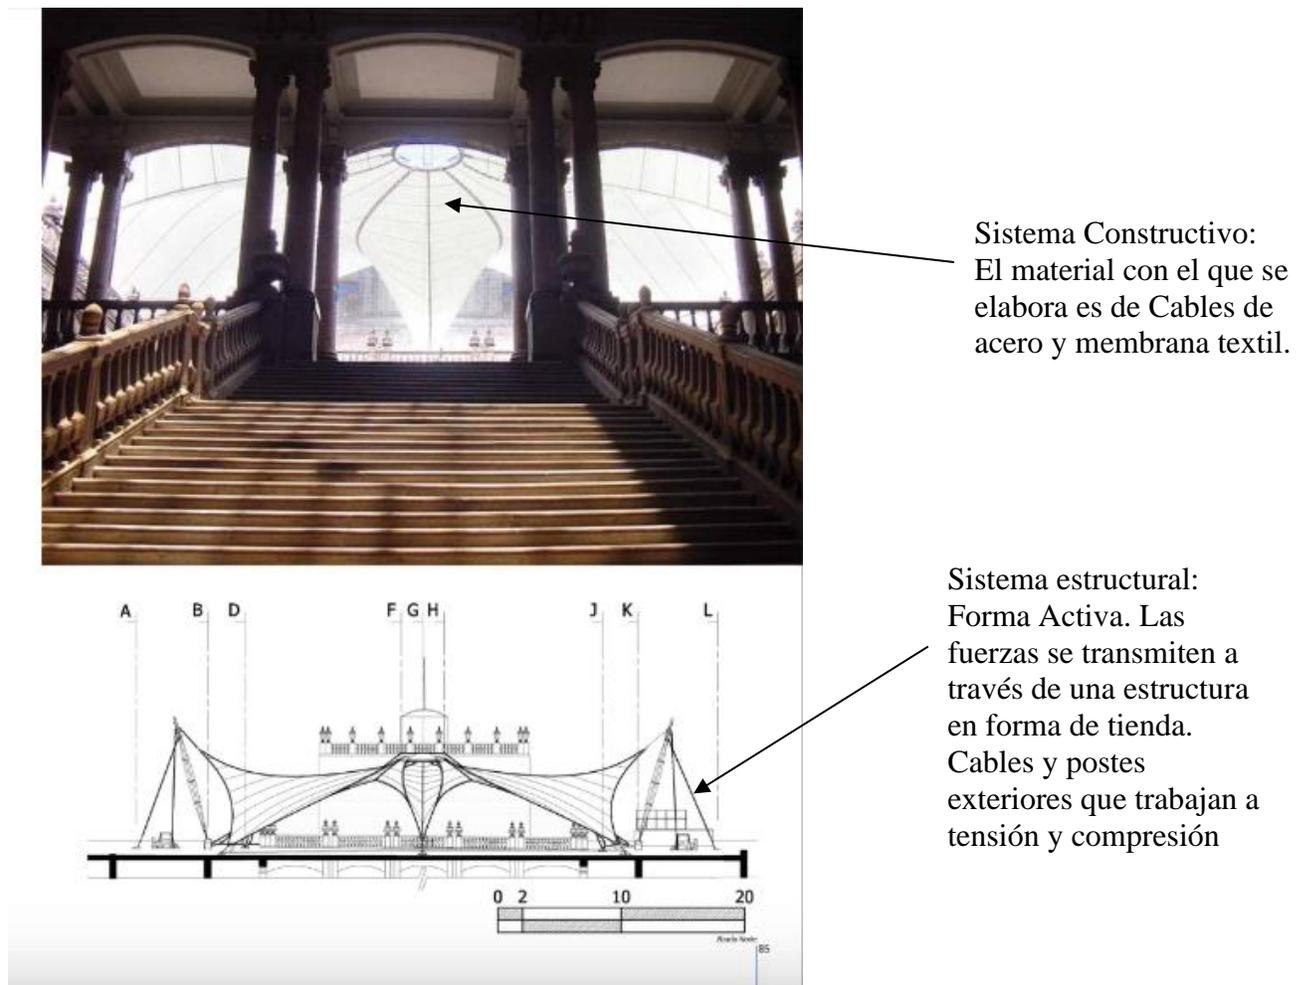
que muestra la diferencia entre sistema estructural y sistema constructivo.
